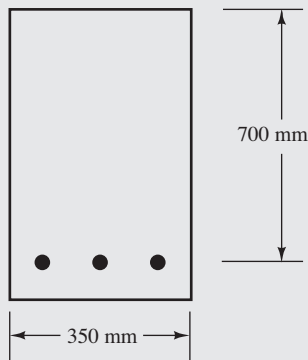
Sección transversal de la viga del ejemplo 5.12.
